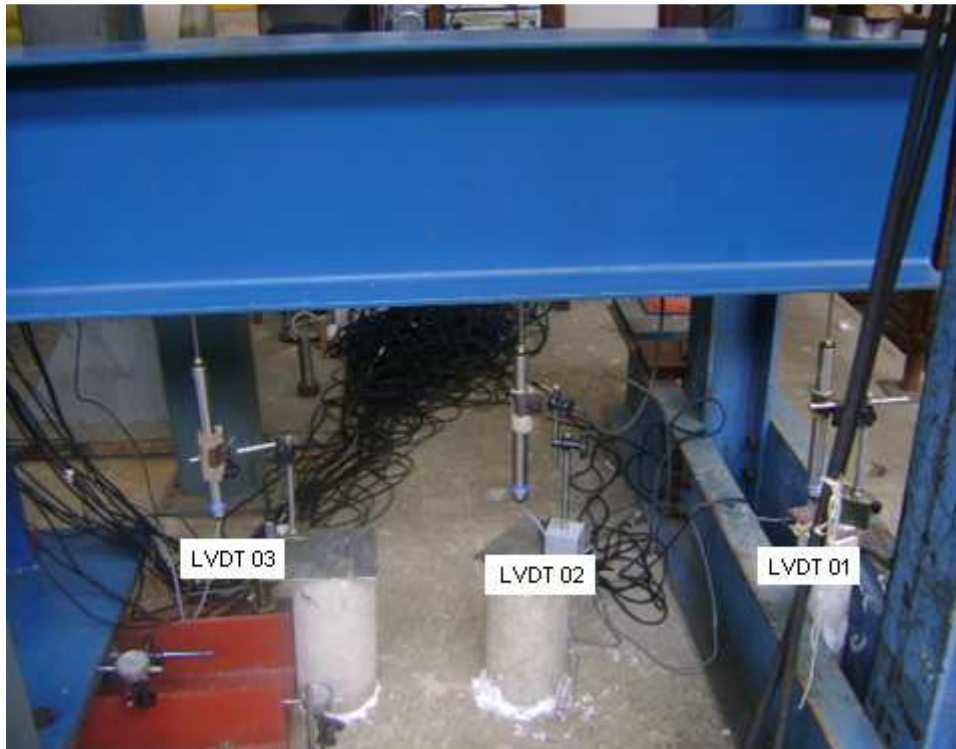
Posição dos LVDT's 1, 2, 3 na parte inferior da viga
